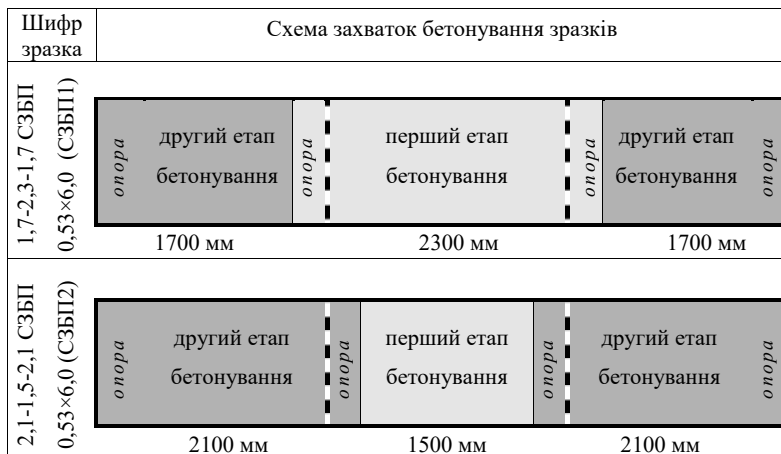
Схема етапів бетонування двох зразків сталезалізобетонних трипролітних нерозрізних плит по незнімній опалубці із профнастилу
